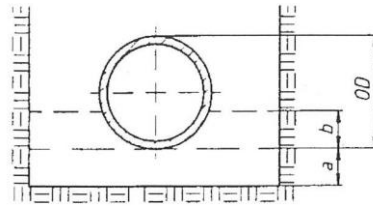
Bettung Typ 1 (nach DIN EN 1610, Bild 3)
